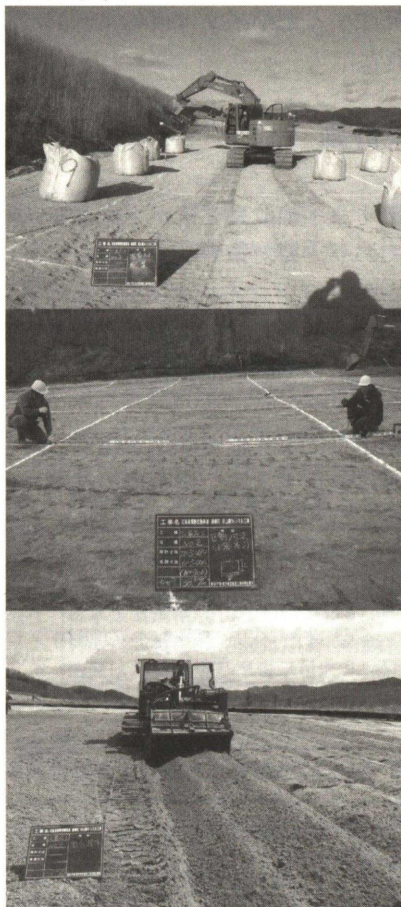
吸着層施工状況（区割り・吸着材配置・攪拌）
